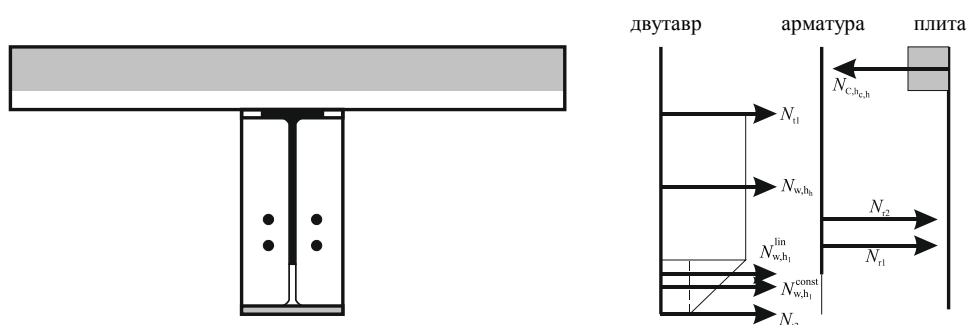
Внутренние усилия в отдельных элементах сталежелезобетонного сечения
